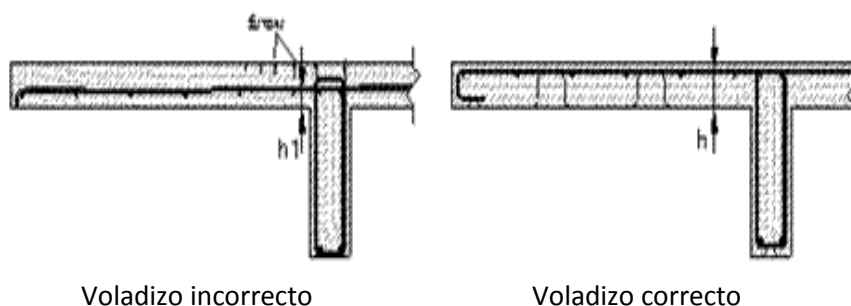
fisuras en los elementos solicitados a flexión
